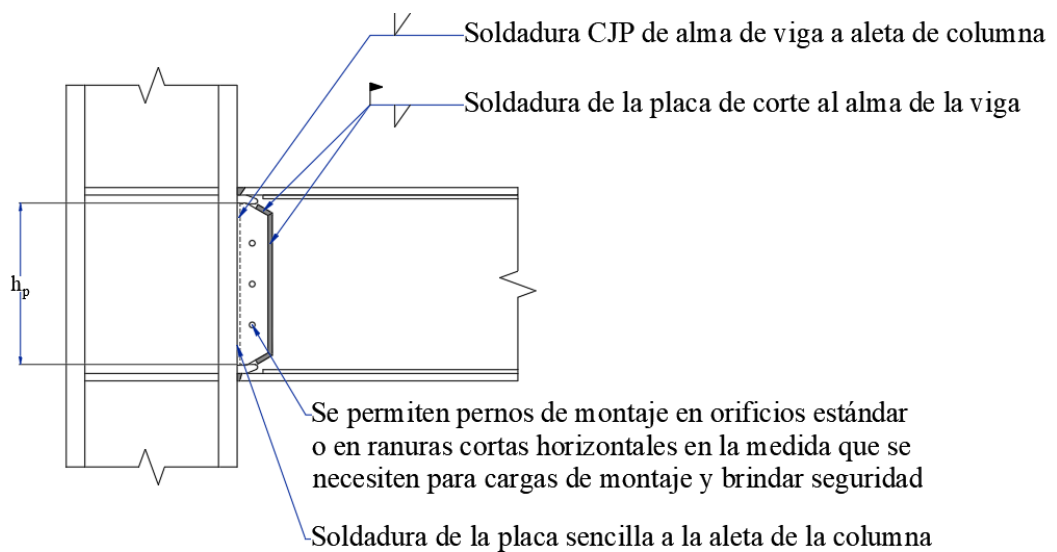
Detalles generales de la conexión alma de viga a aleta de columna (ANSI/AISC 358, 2018)pg71
